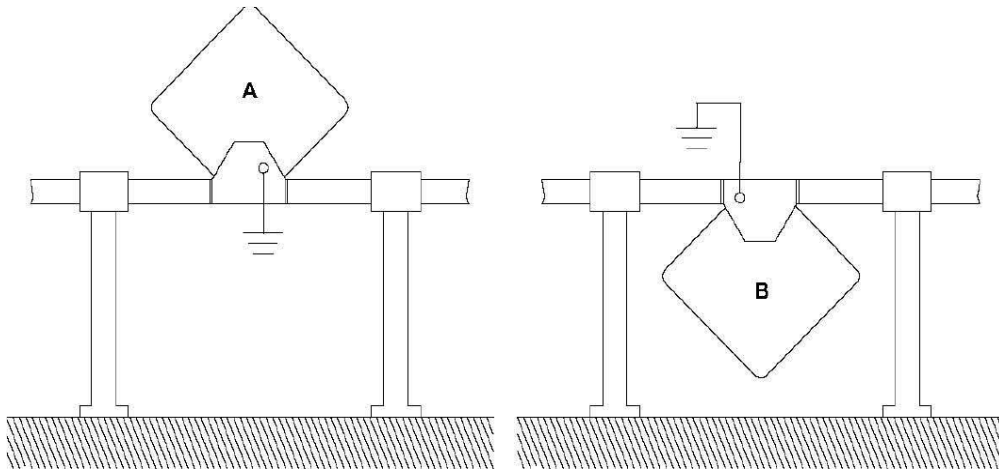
INSTALAÇÃO HORIZONTAL RECOMENDADA
